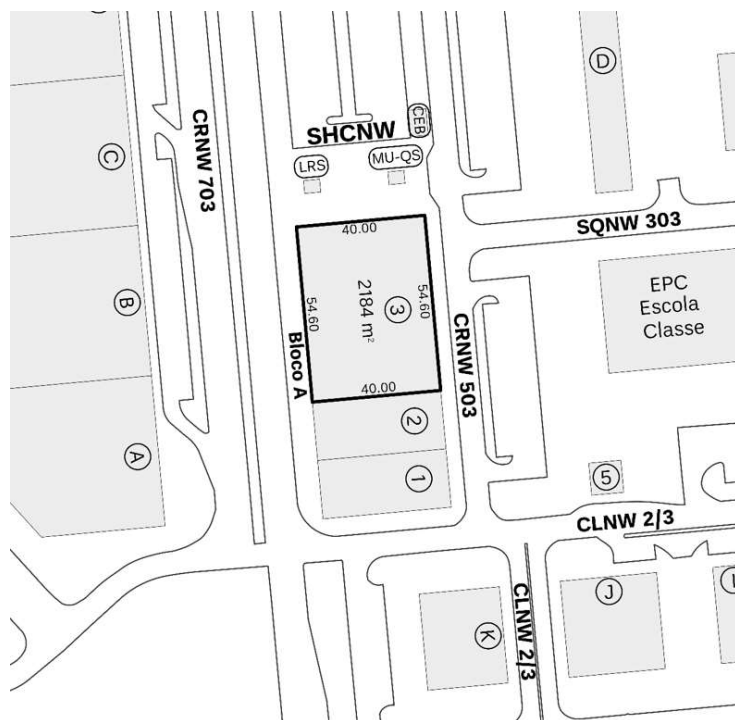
Croqui da Situação Proposta. Fonte: MDE 200/2024
